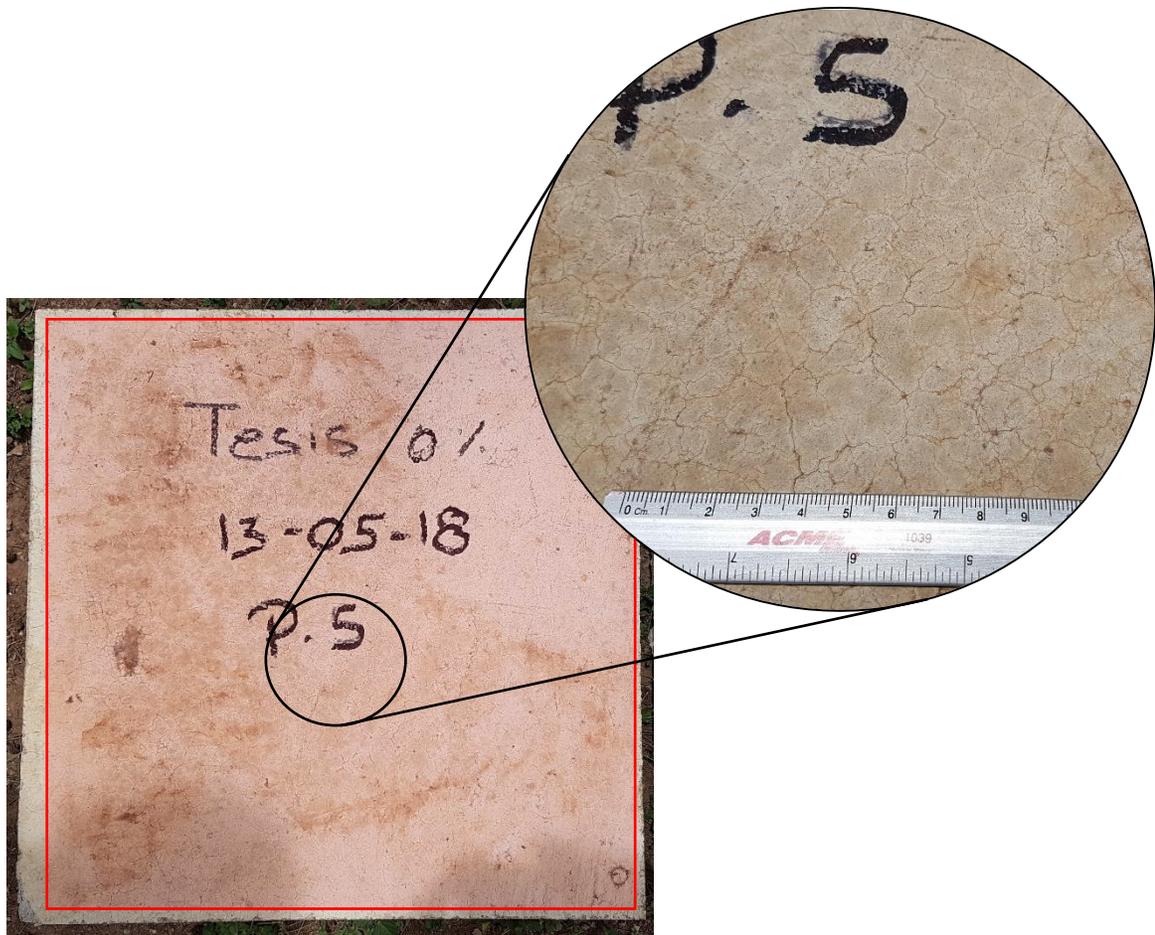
Losa de concretó hidráulico, 100% fisurada a los 21 días
